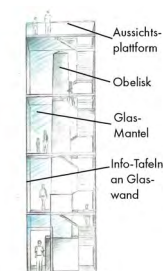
Kriegerdenkmal mit Glasmantel im Detail
